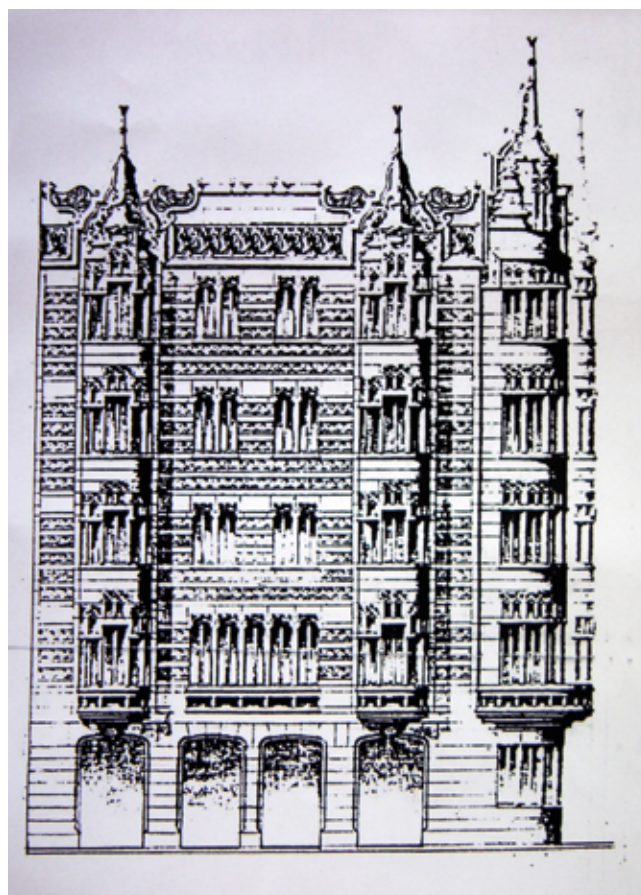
Fachada a la calle de La Merced, plano realizado para el propietario.
